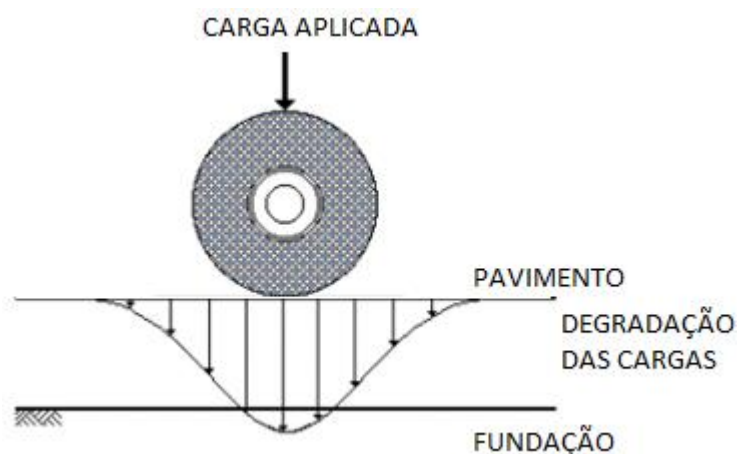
Efeito da degradação das cargas num pavimento flexível (Pavimentos, 2009)
